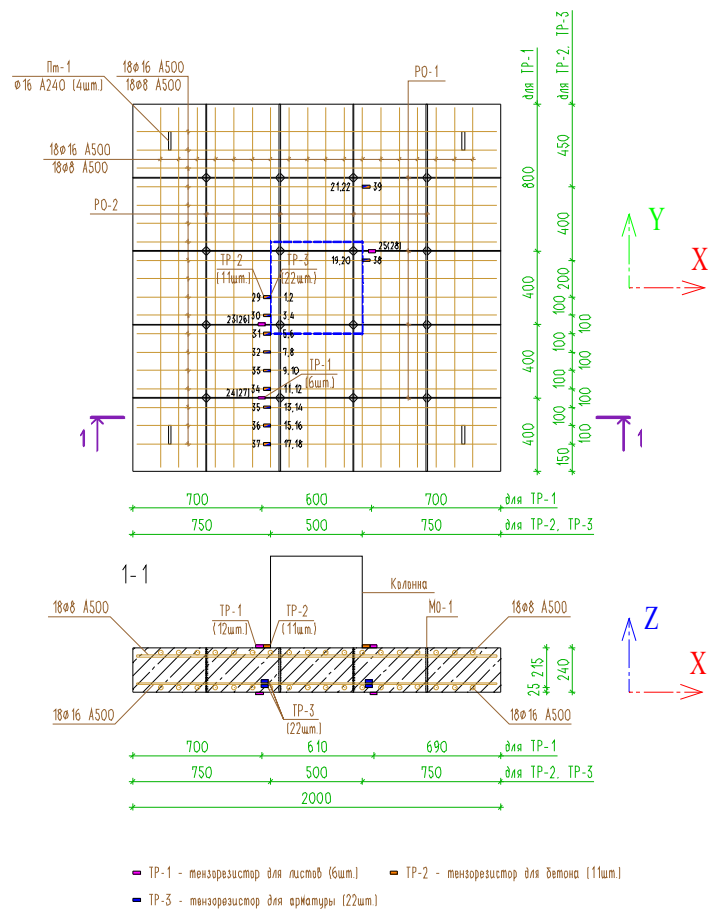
Фрагмент плиты перекрытия 6 (ФПП-6), РС66
